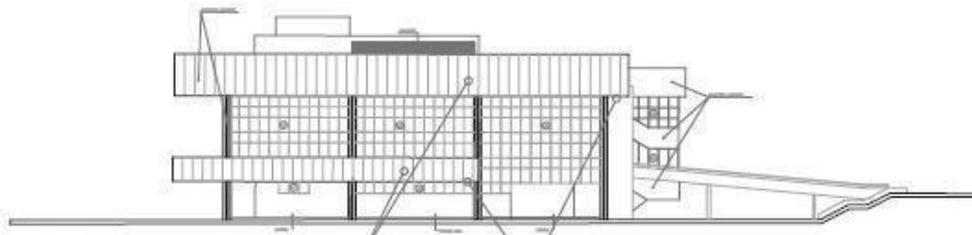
Fachada Norte da Biblioteca Central/UFC Arq. Nearco Araujo
